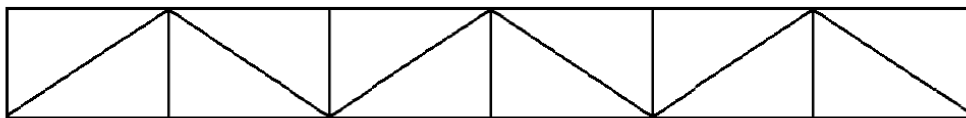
Transversalbalkar då diagonalerna möts i underramen.
